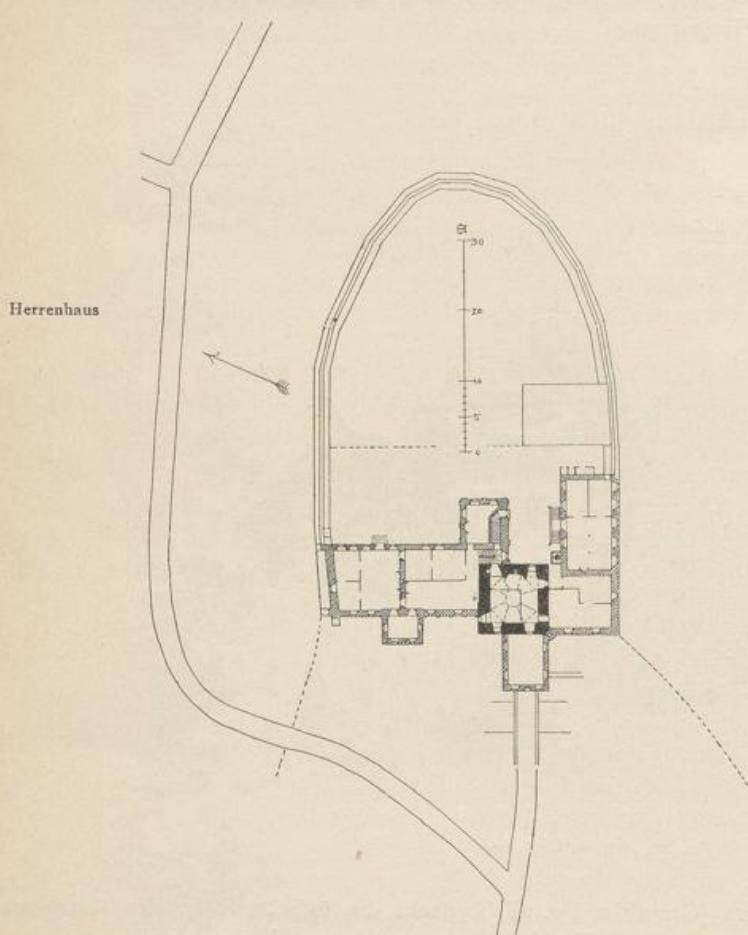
Liedberg. Grundriss des Schlosses.
